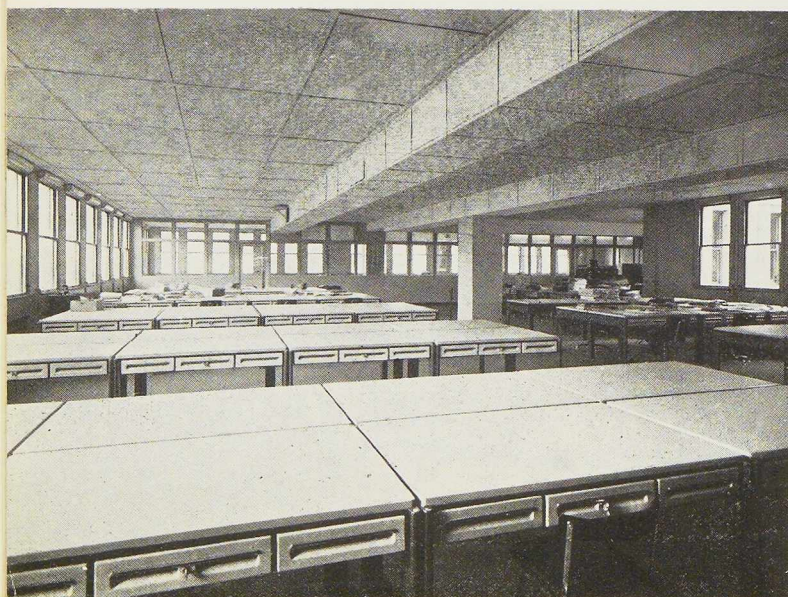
L'armature portant les panneaux de tôle d'un plafond.
